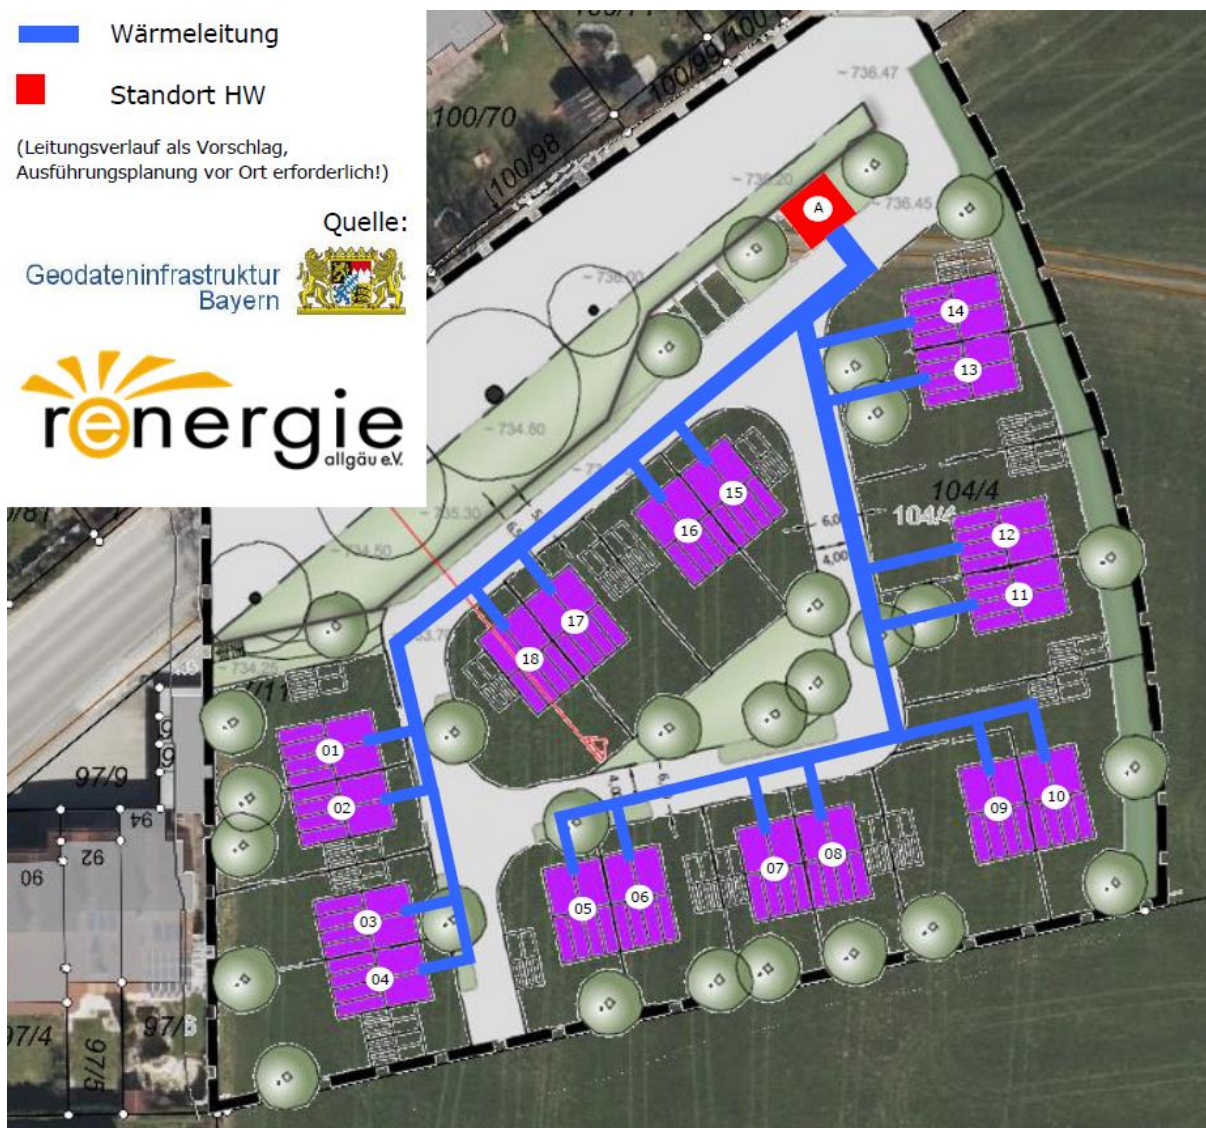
Bebauungsplan – Holzheizwerk und Leitungsschema
